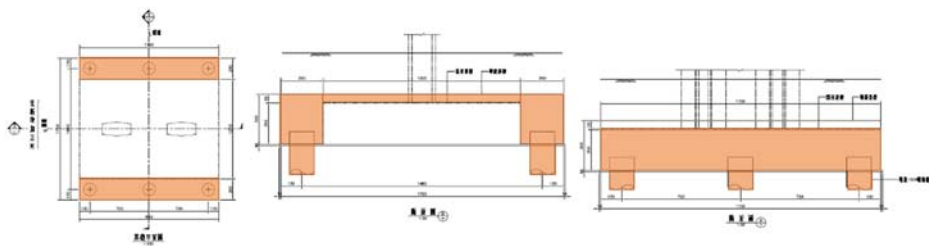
和美交流道匝道一高架橋 P108 基礎補強示意圖
